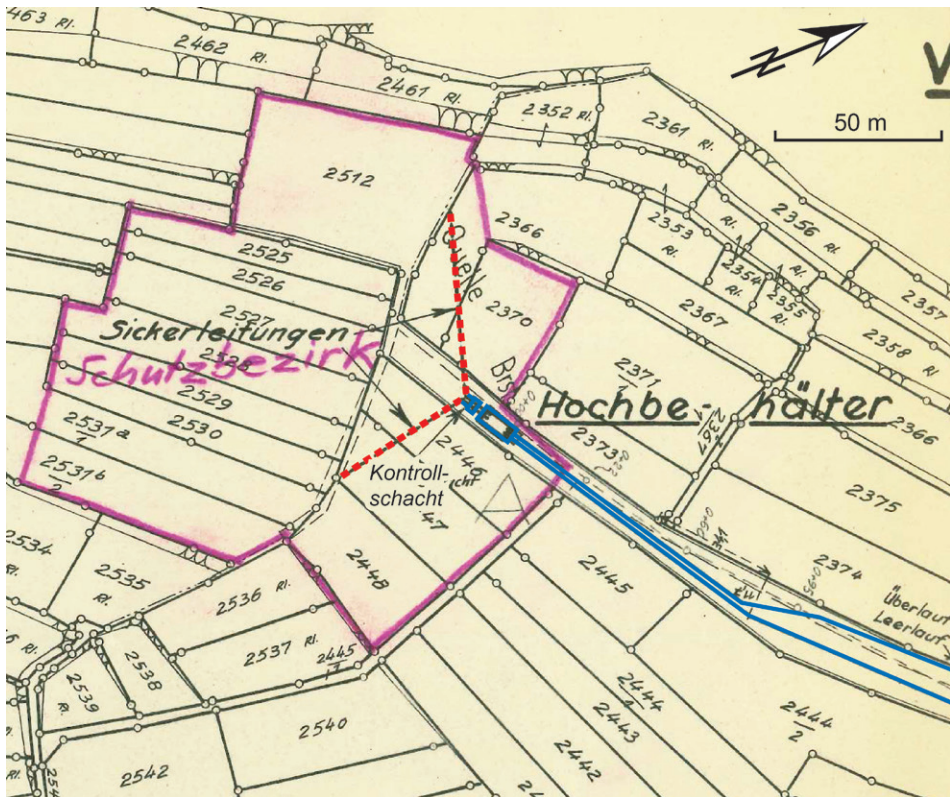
Quellen der Wasserversorgung der ehemaligen Riegeler Brauerei. Lageplan mit den Fassungssträngen der beiden Quellen, dem Quellschacht („Kontrollschacht“), dem Wasserreservoir („Hochbehälter“) und den Wasserleitungen. Wasserwirtschaftsamt Freiburg, 18. Juni 1955. Bearbeitung: Gabriele Fischer, LGRB. Fig. 67: Springs formerly connected to the water supply scheme of the former Riegeler brewery. Site plan.
